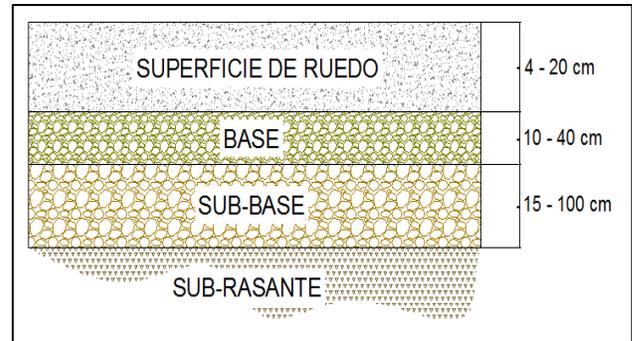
Estructura del pavimento flexible (Autor, 2013).
